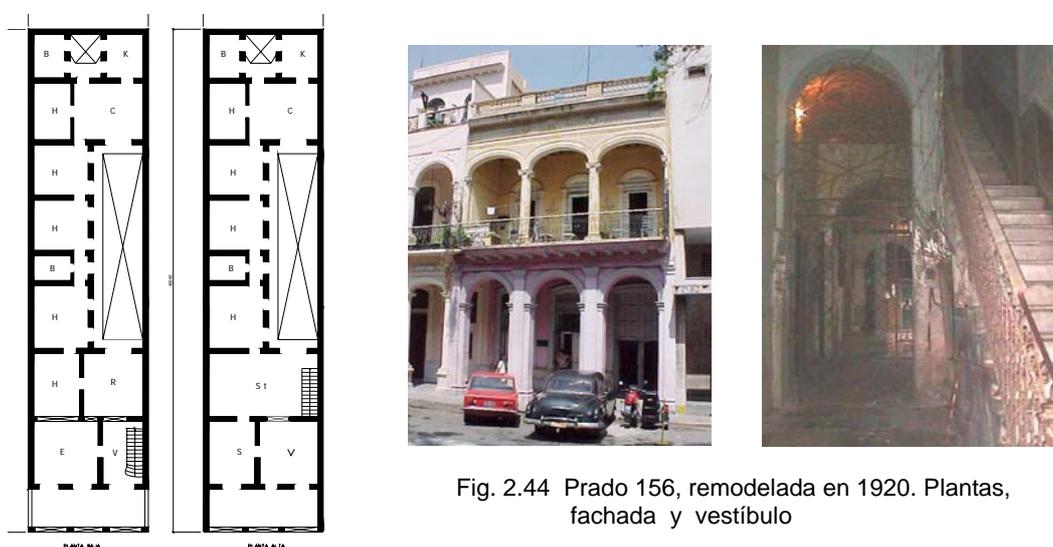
Prado 156, remodelada en 1920. Plantas, fachada y vestíbulo
